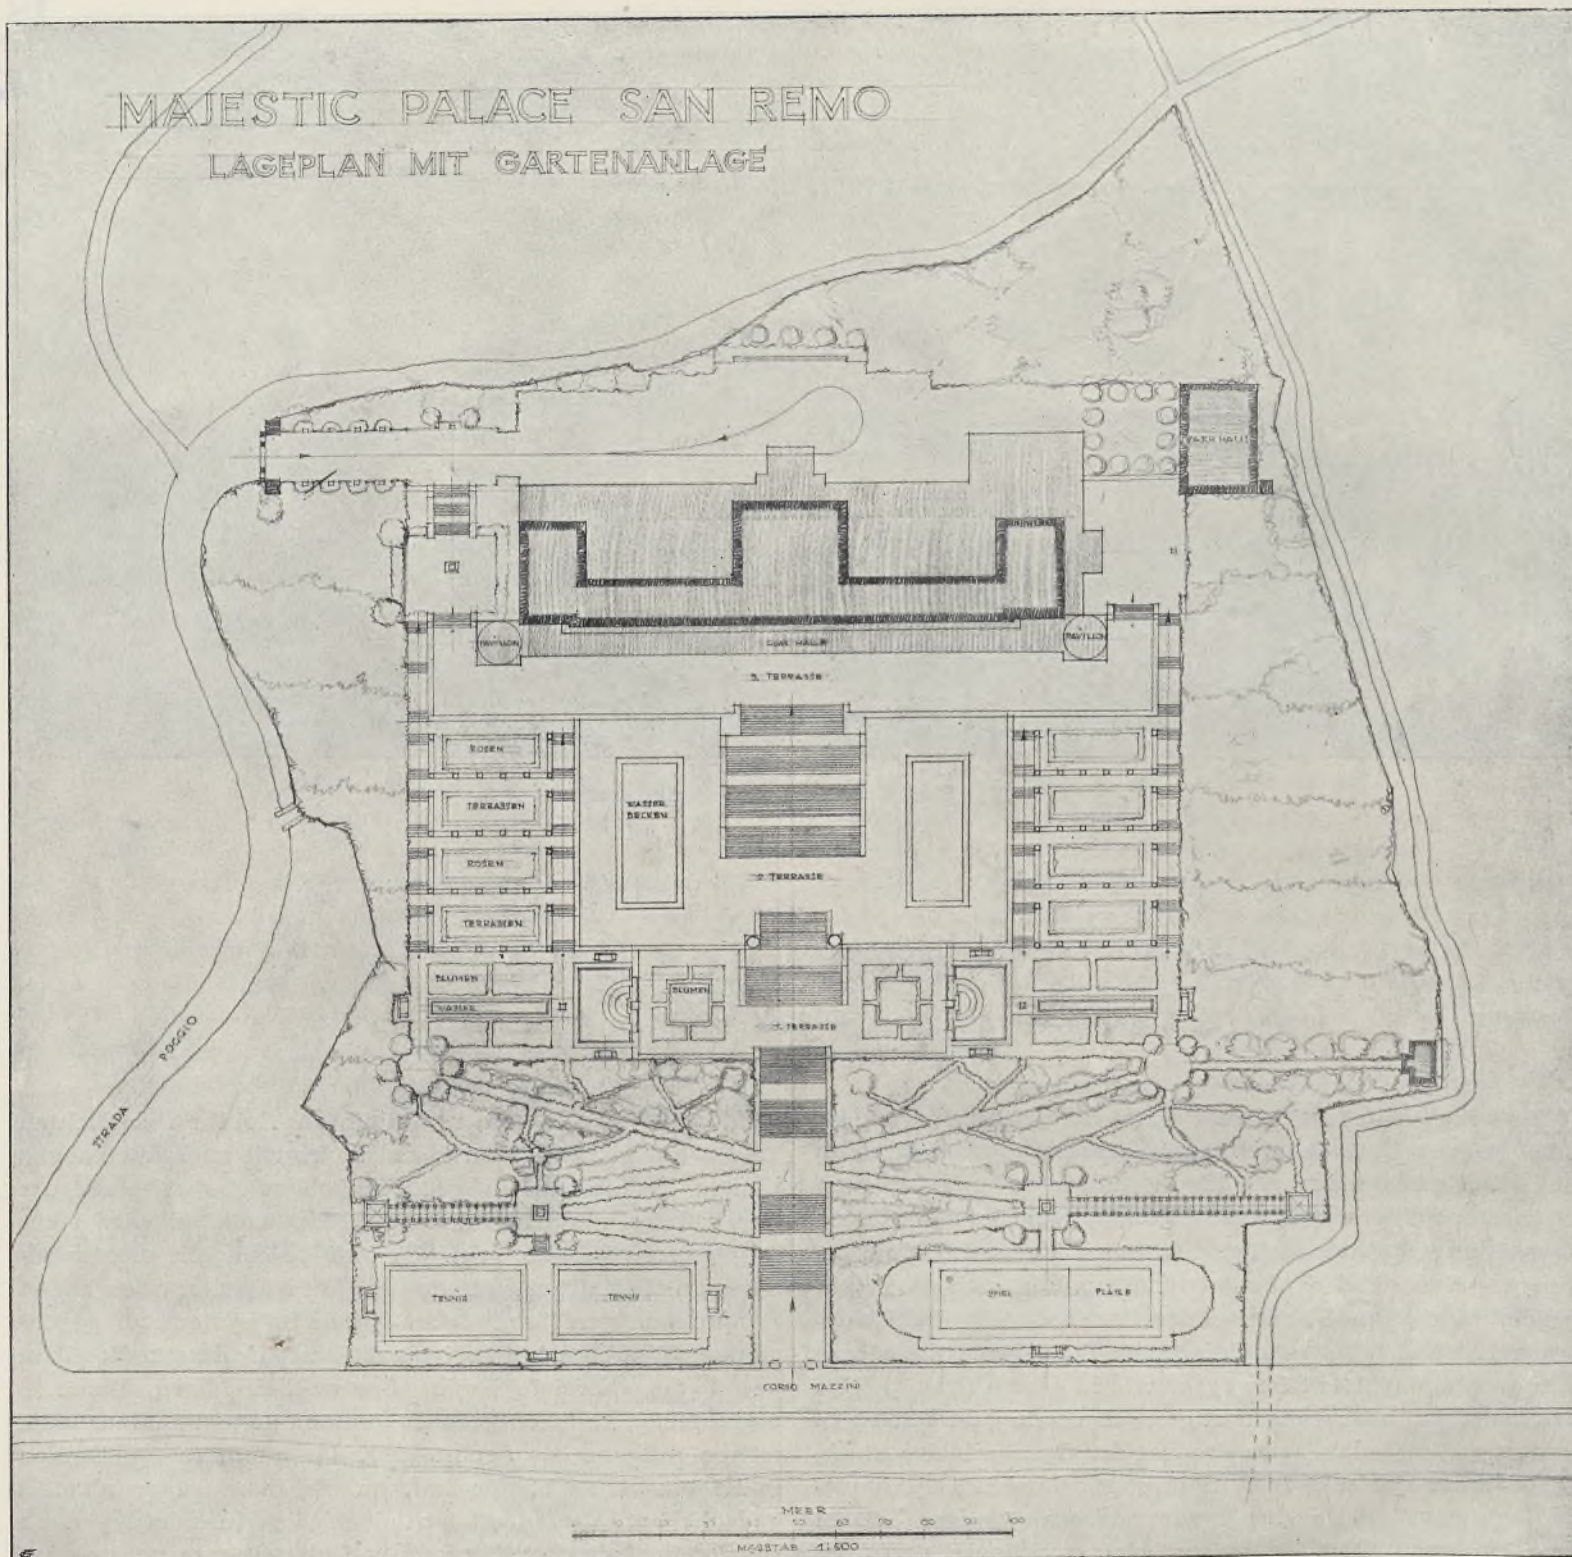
Peter Behrens, Hotelprojekt, Lageplan.
